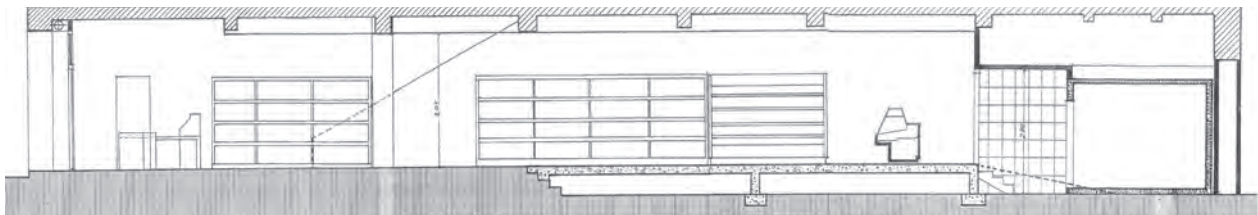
15. 1988 SECCIÓN DE LOCAL COMERCIAL EN PLANTA BAJA
